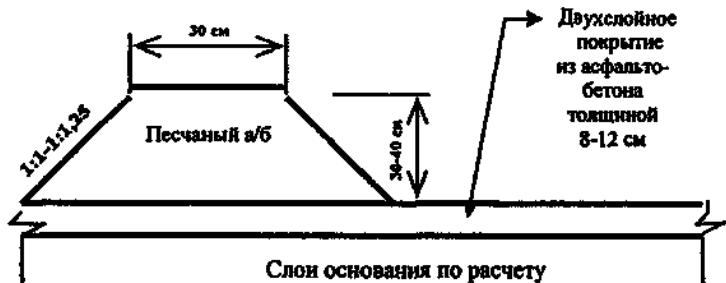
Обваловка открытой площадки для хранения сыпучих бестарных химических и комбинированных ПГМ
